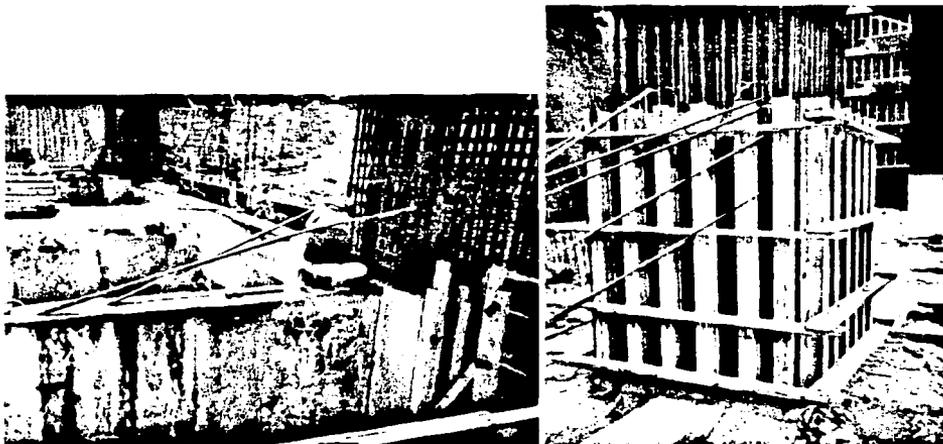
Colocación de acero de refuerzo y cimbrado en columnas de sótanos.
